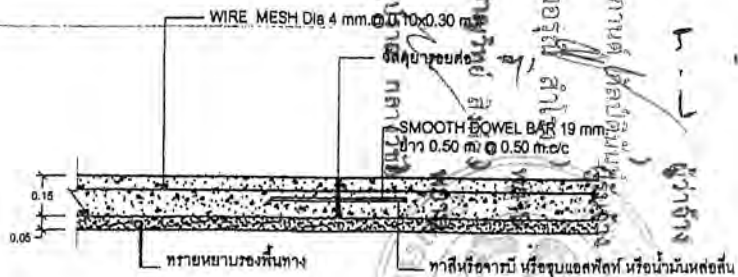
DETAIL. CONSTRUCTION JOINT (รอยต่อเพื่อการก่อสร้าง)
